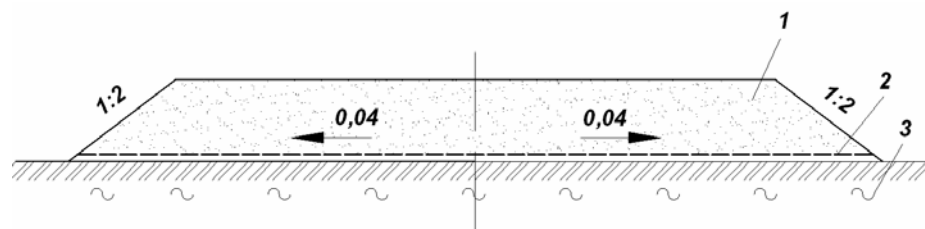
Конструкция насыпи с прослойкой из НСМ на участках переувлажненных грунтов
